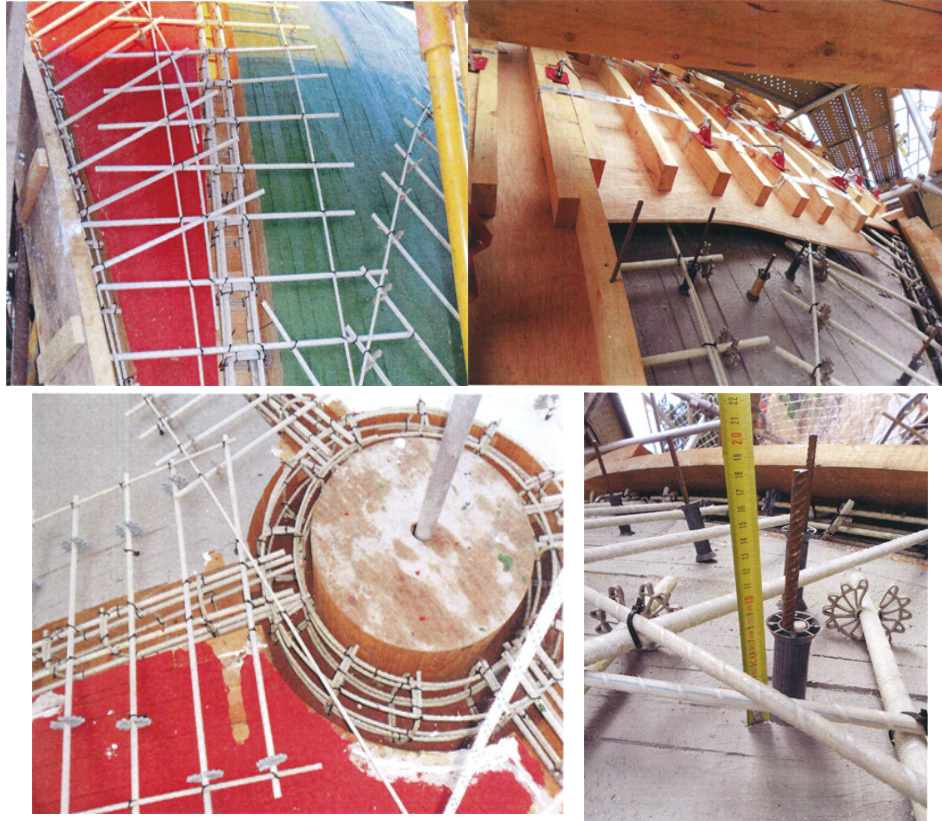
Detalle de armadura de los nervios y plementería de la bóveda
